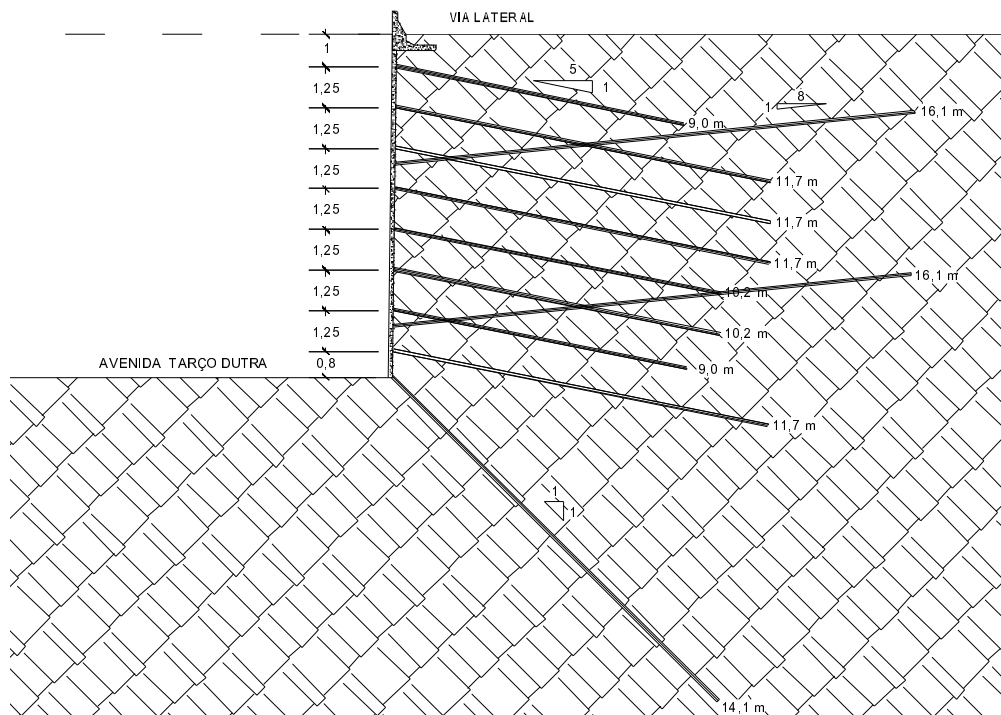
seção transversal reforçada após a observação de trincas de tração à montante da escavação (dimensões da retroanálise conforme projeto original)
